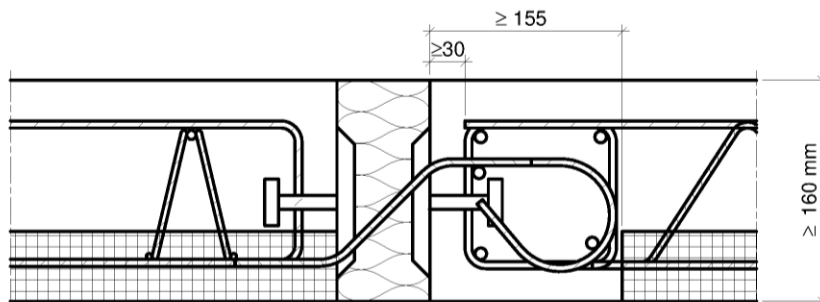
Beispiel Schöck Isokorb® Typ Q (mit abgebogenem Querkraftstab) mit Elementplatten
